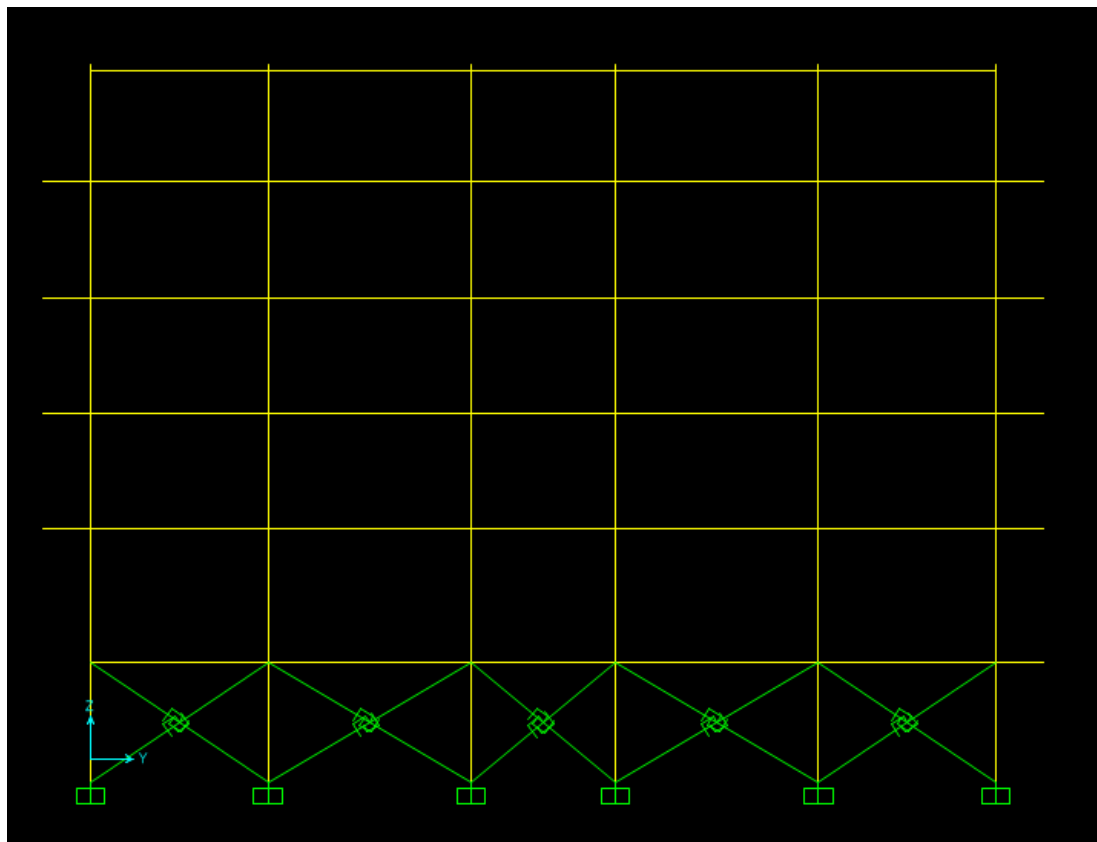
Prospetto lato Ovest, edificio Fazzini
